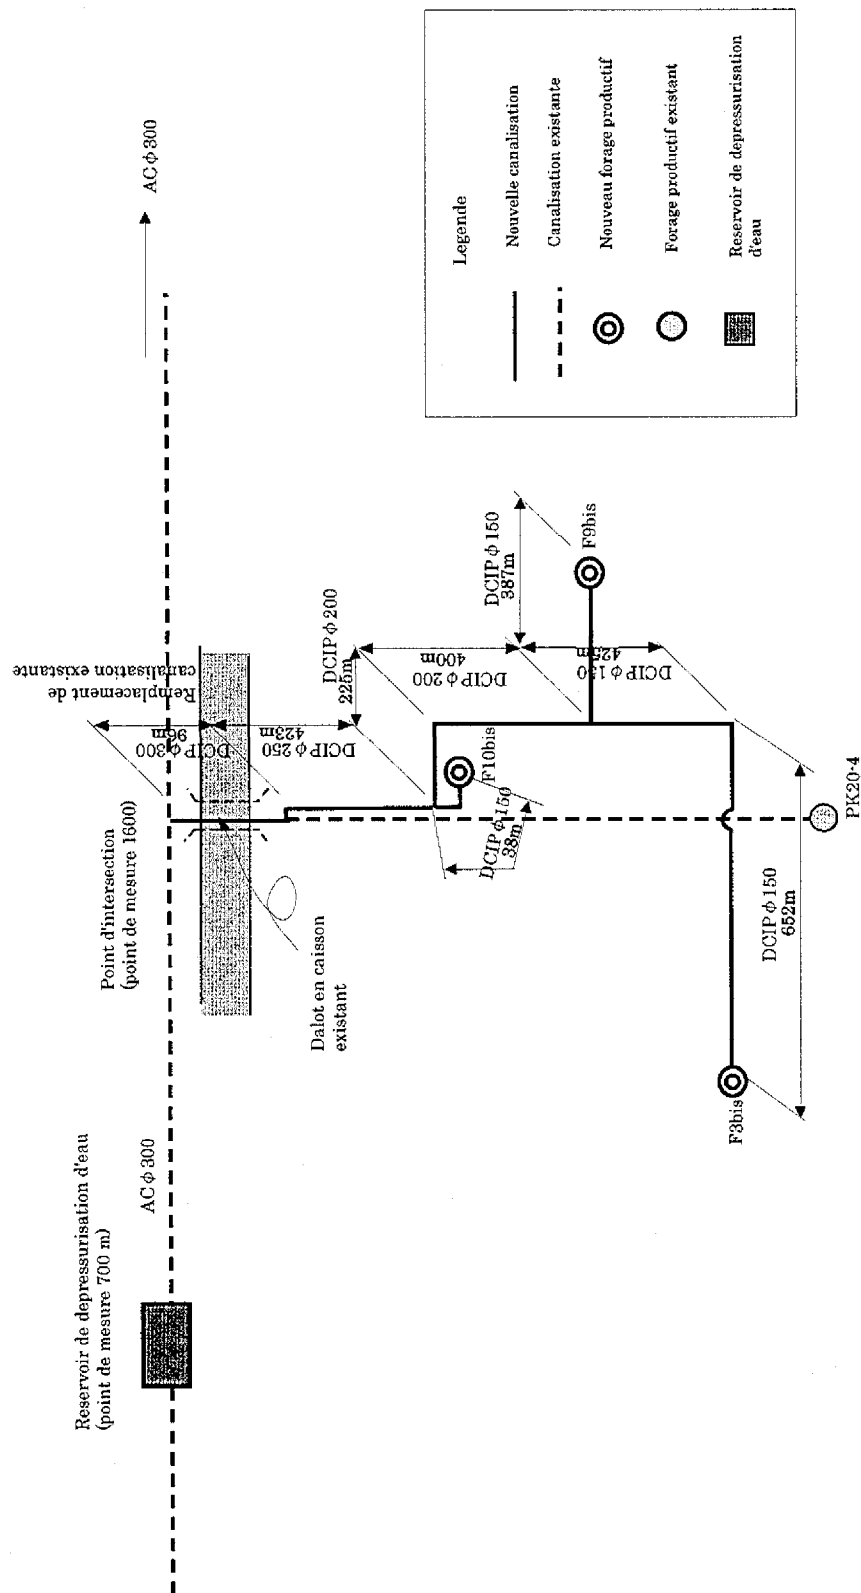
Plan des canalisations de transport d'eau de la zone PK20 (Sans échelle)
